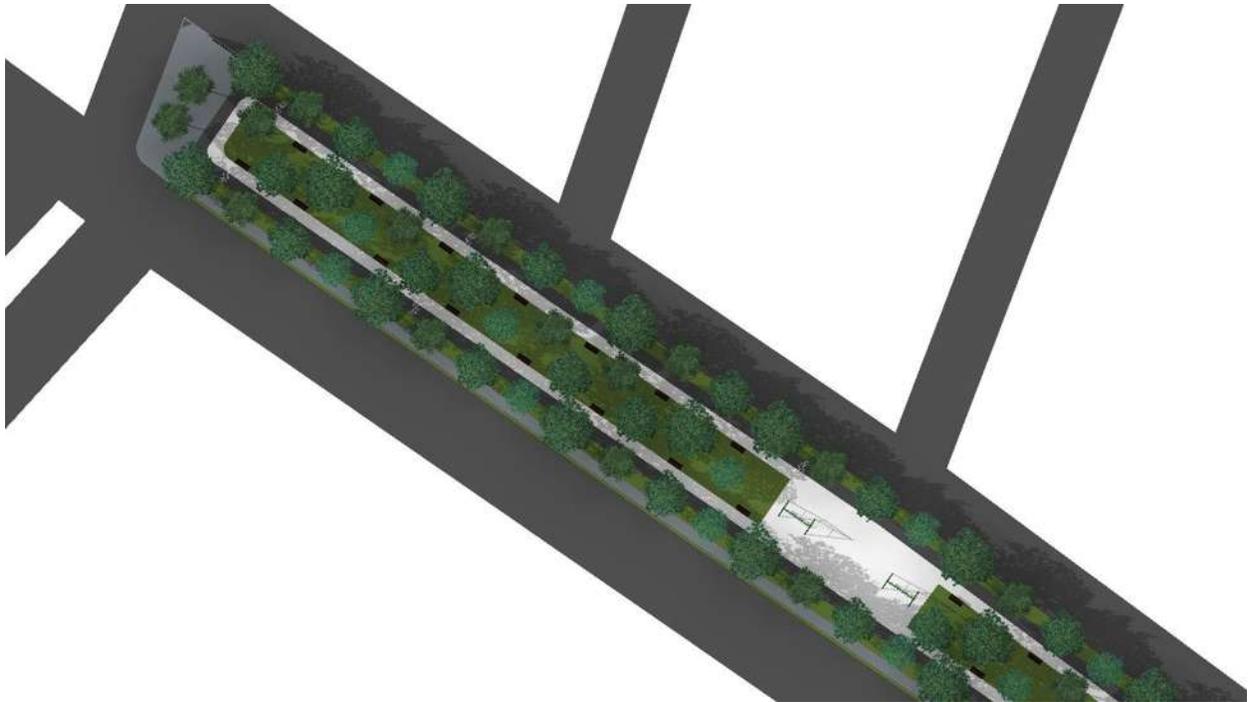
Vista en planta de propuesta de diseño 2. Elaboración propia.
